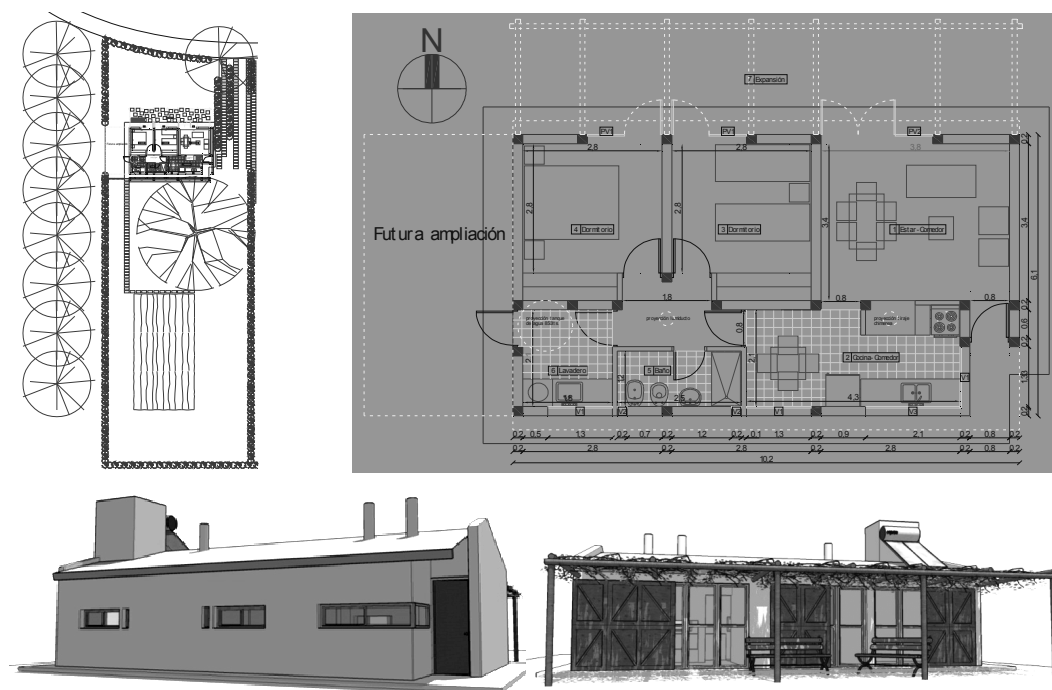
Ubicación de la vivienda dentro del terreno. Esquema planta. Volumetría fachada norte y sur.
